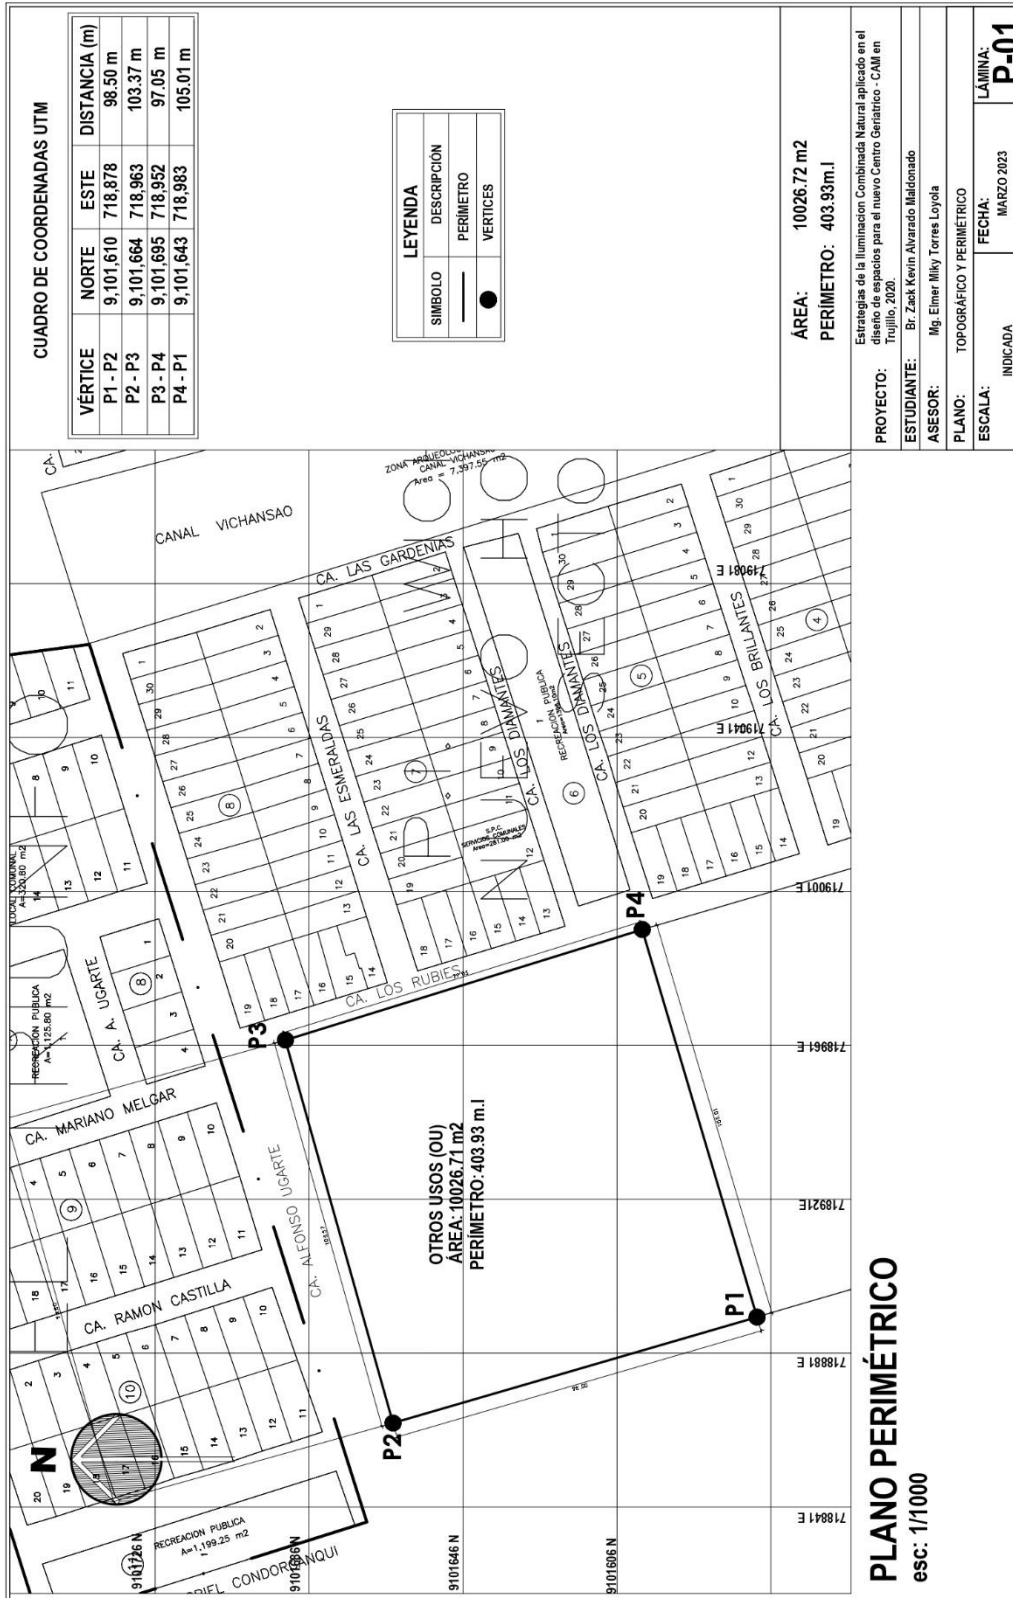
Plano perimétrico de terreno seleccionado. Fuente: Elaboración Propia
